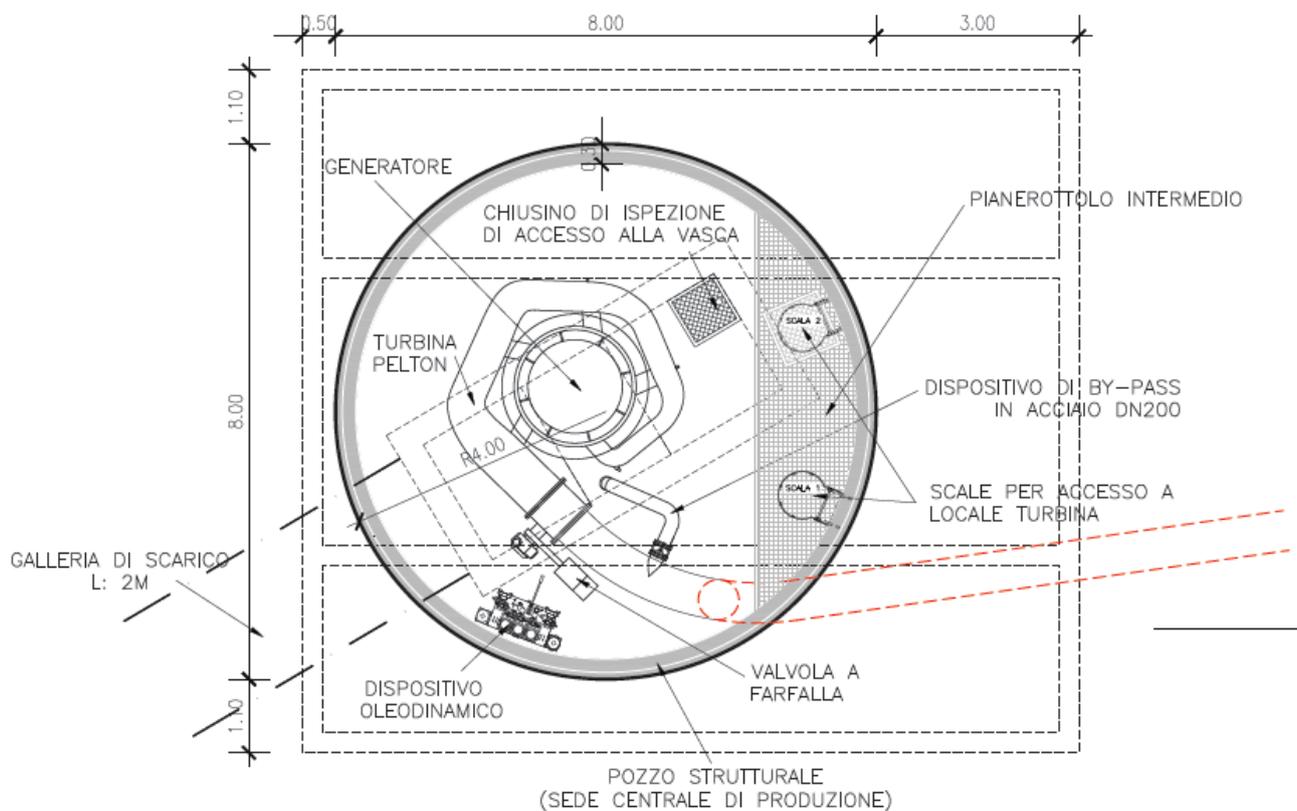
laddove si riporta la pianta dell'edificio della centrale di produzione.
